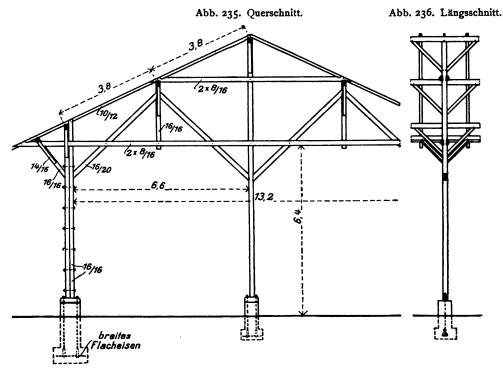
u. 236. Binder für einen nicht durch Streben eingeschränkten Raum. M. 1: 140.
